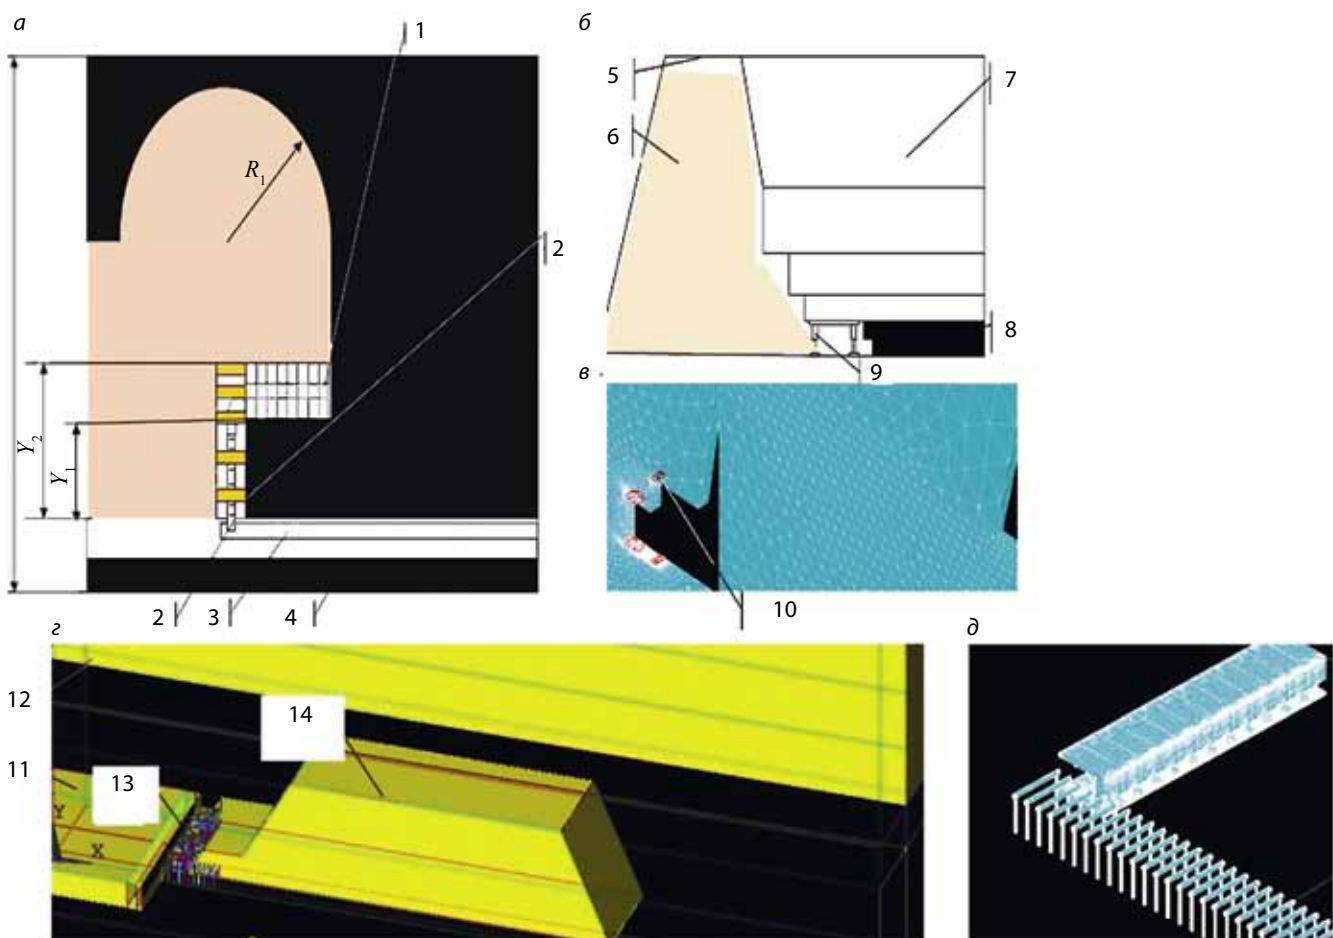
Расчетная схема: а – схема: 1 – камера; 2 – КПС в выработке и камере; 3 – конвейер штрека; 4 – целик; б – схема: 5 – сводообразование; 6 – обрушение; 7 – породы ВУ; 8 – пласт у камеры; 9 – выработка с СПК; в – сетка КЭ; 10 – зоны нагрузки от крепи; г – элементы 3d-модели: 11 – пласт с зонами дезинтеграции; 12 – свод; 13 – крепь и СПК; 14 – обрушенные породы из свода; д – сетка КЭ для крепи камеры и СПК
